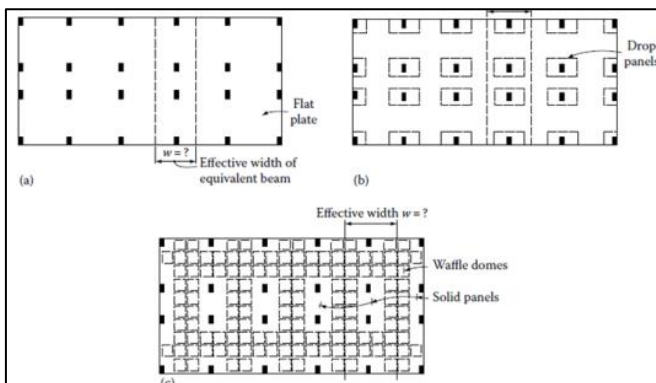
Systèmes typiques de plancher des dalle-cadres plats : (a) dalle plate, (b) dalle plate avec des panneaux de baisse, et (c) système bidirectionnel de Waffle
